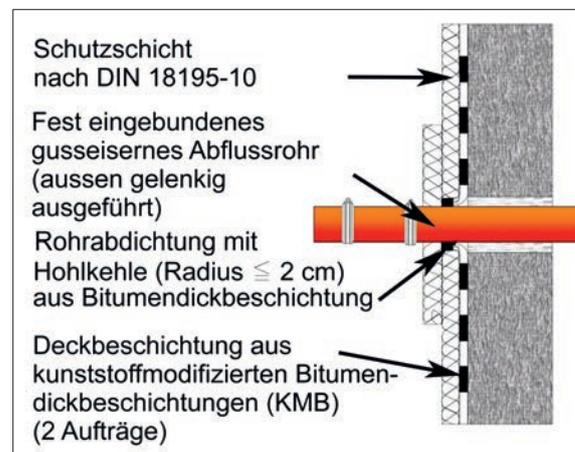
„Ausführungsbeispiel: Wanddurchführung für Lastfall Bodenfeuchte / nichtdrückendes Sickerwasser gemäß DIN 18195-4“
